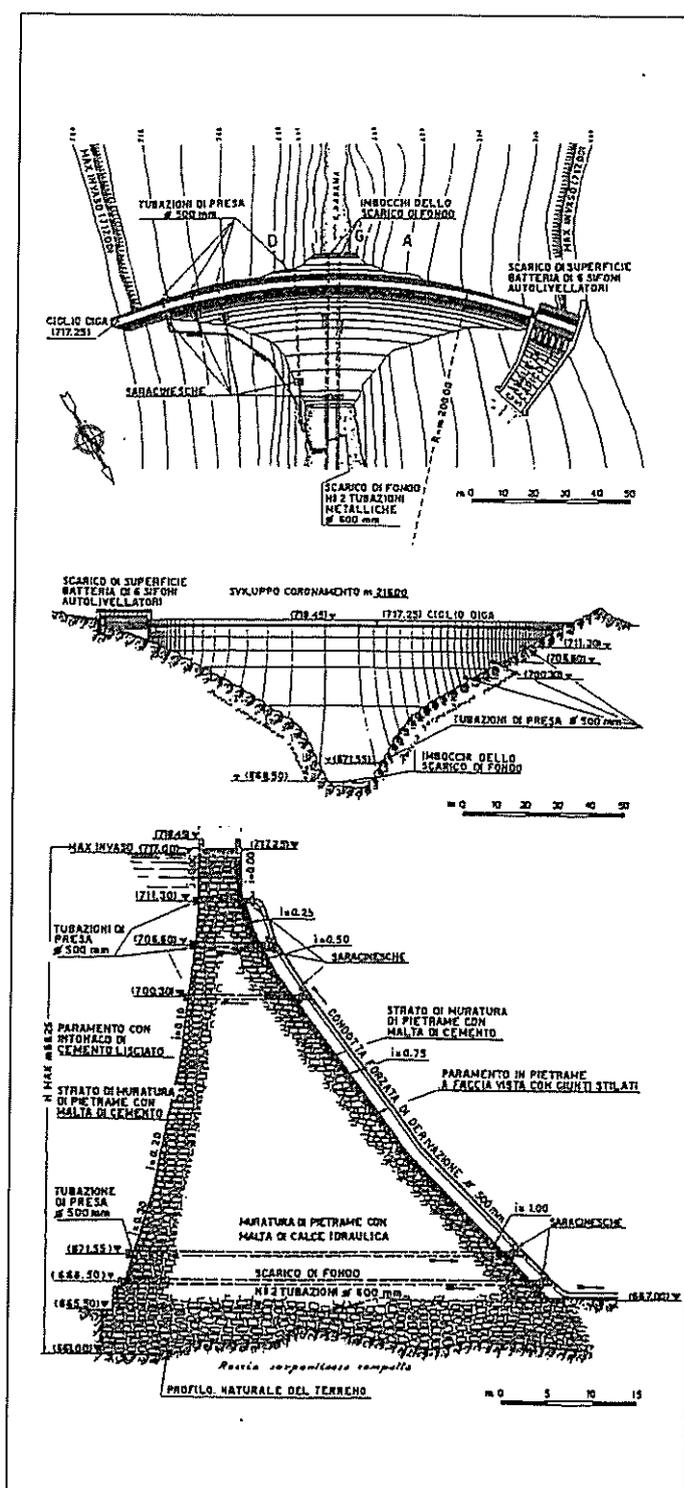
Diga Lago Badana: Planimetria - Vista da monte - Sezione tipo.
